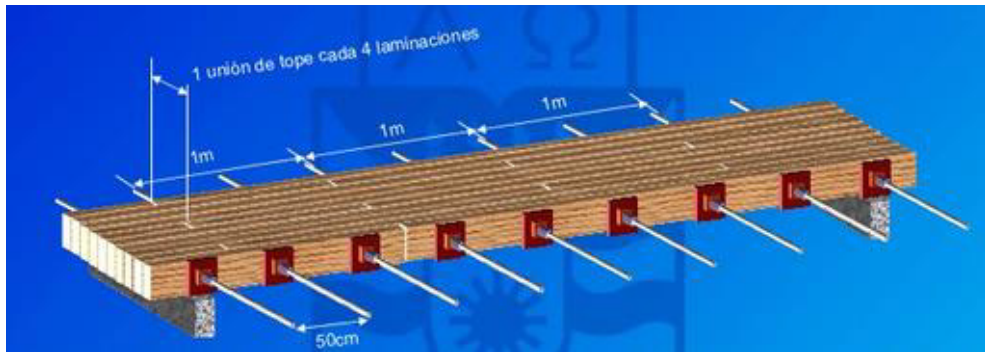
Tablero Tensado (Tomado de Congreso de Puentes de Madera, 2008)
